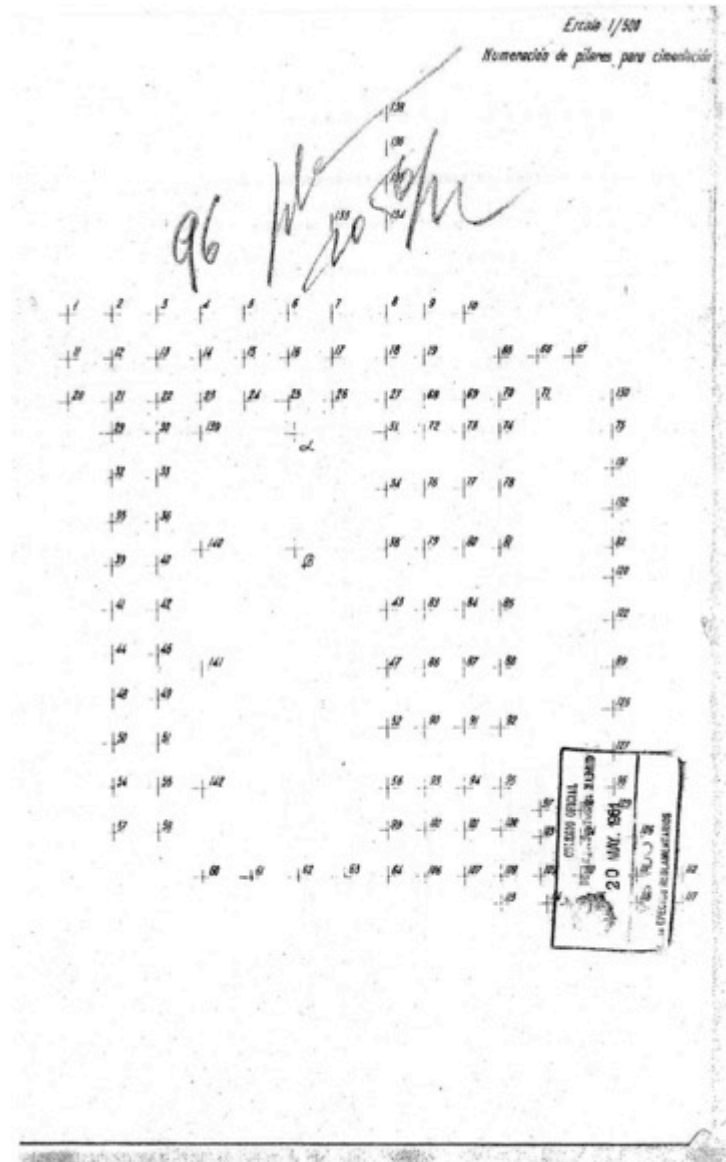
Plano de Pilares (1961) en el que no figuran los pilares intermedios finalmente ejecutados en las naves principales
